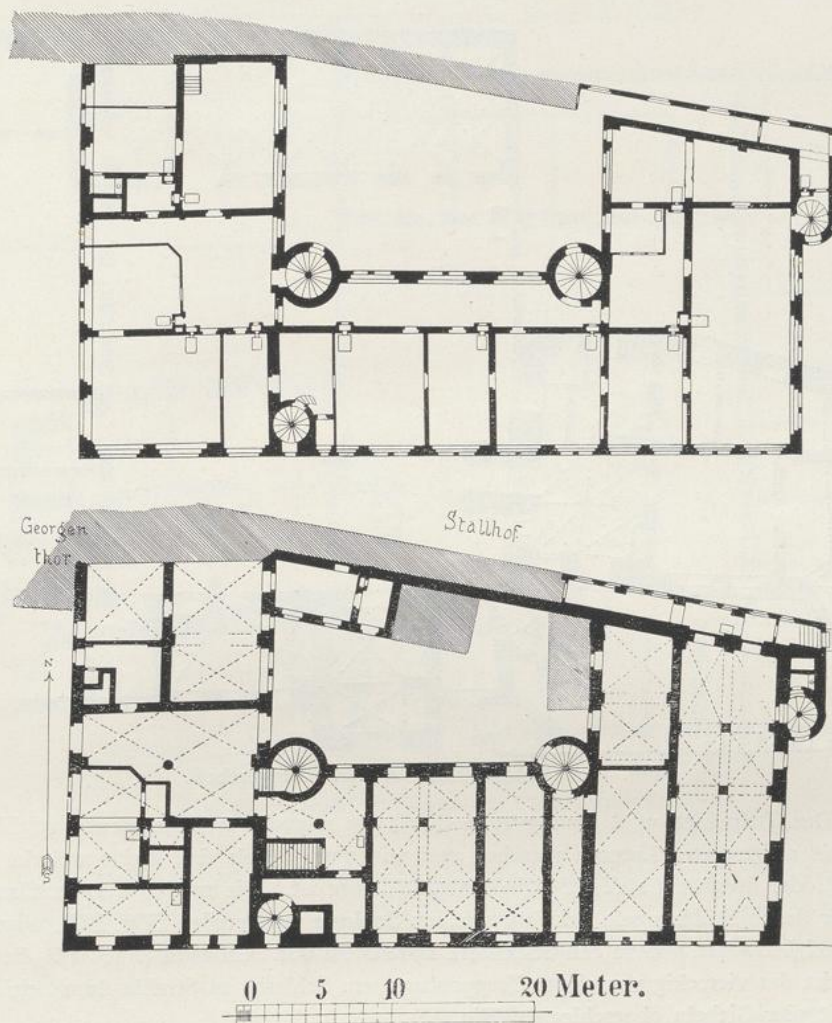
Kanzleihaus zu Dresden. Grundrisse.
